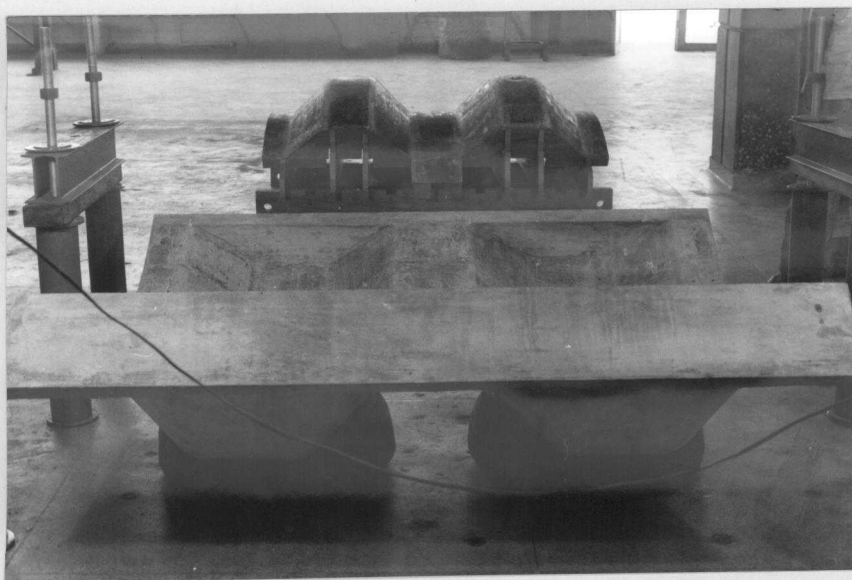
Em primeiro plano a peça, e em segundo plano a fôrma, após a operação de desforma.
